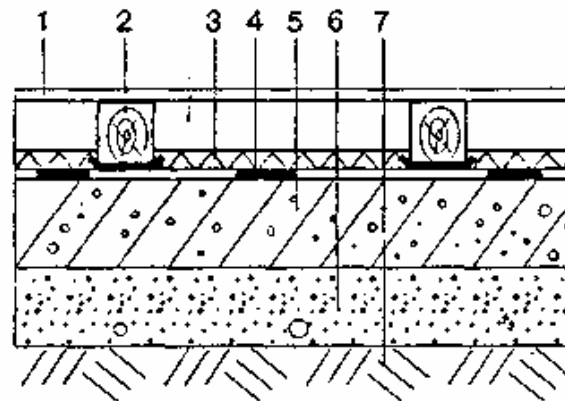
Утеплення підлоги на лежнях на ґрунті:
